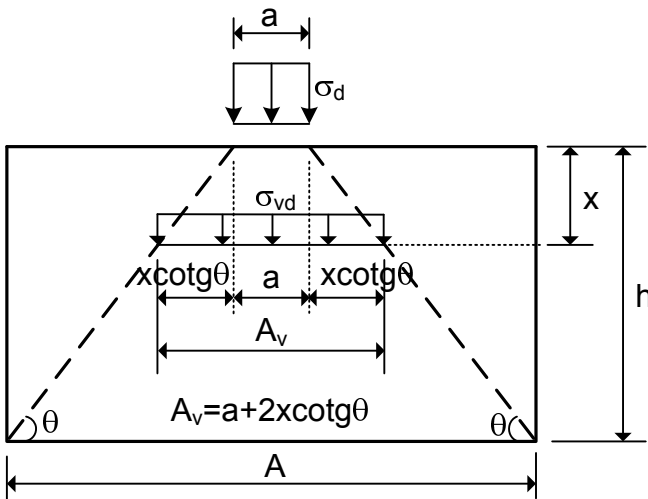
Tensão normal em um plano horizontal dentro da sapata
